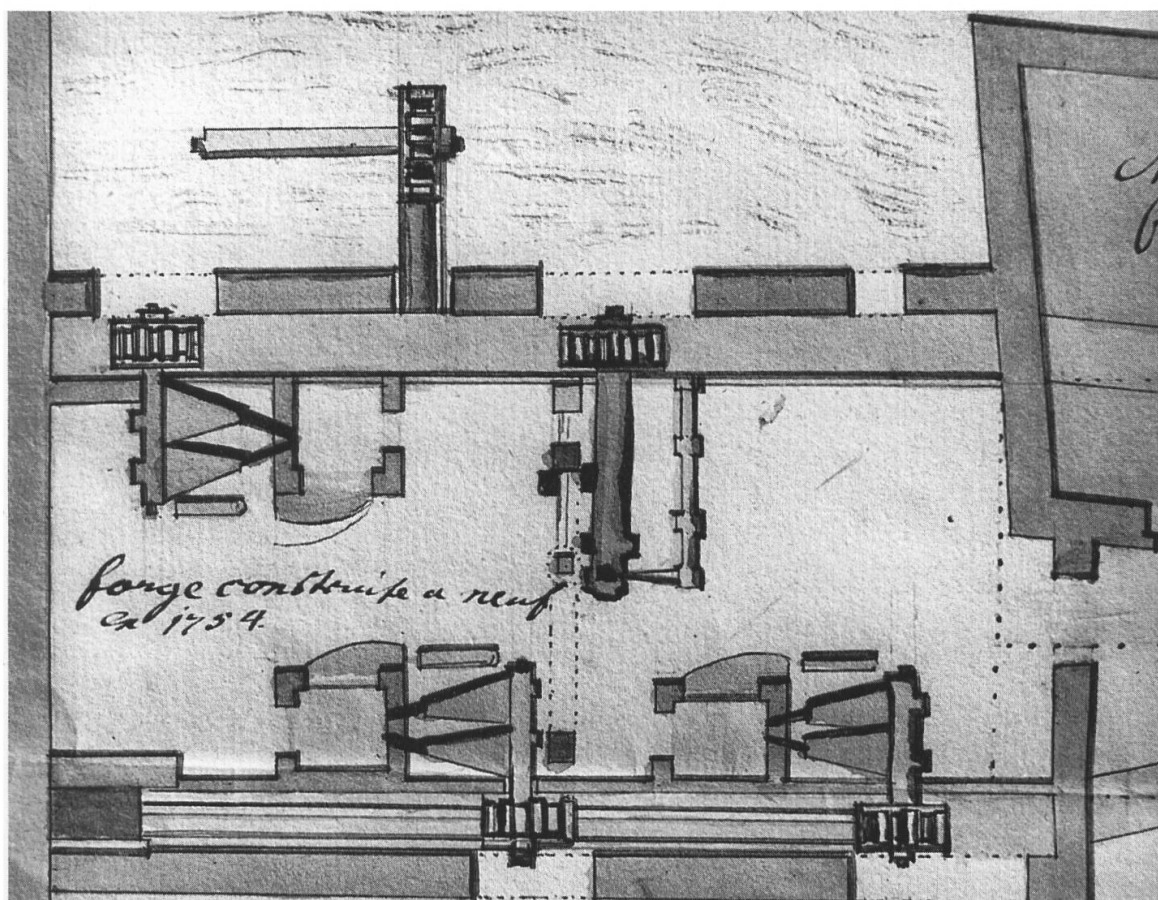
Forge de Chagey (Haute-Saône) : plan de la forge d'affinerie de type wallon en 1754 (A.D. Haute-Saône). Cliché Inventaire Général, Yves Sancey.
